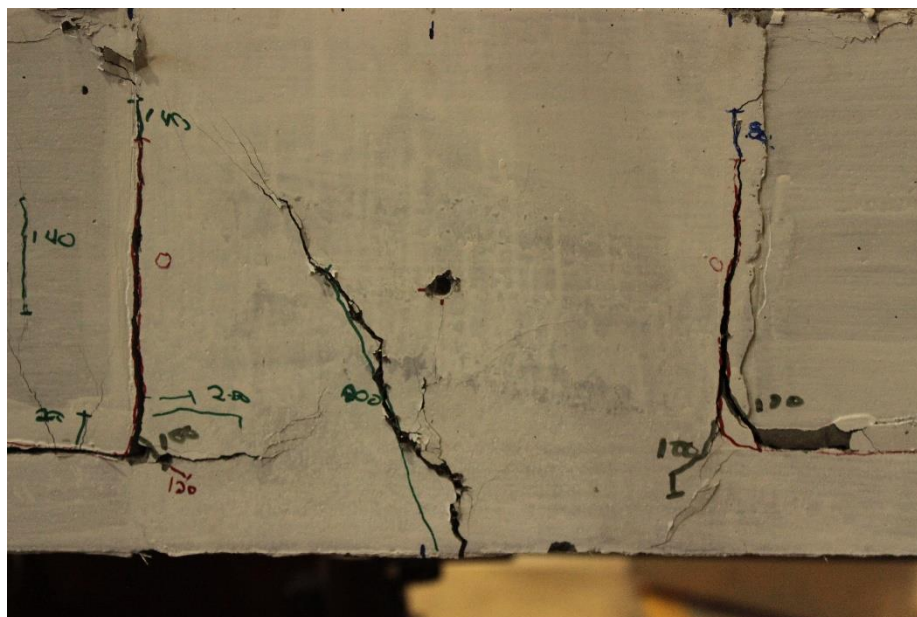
Fissuration au niveau du joint du spécimen avec de grandes ailes (S3-GA)
